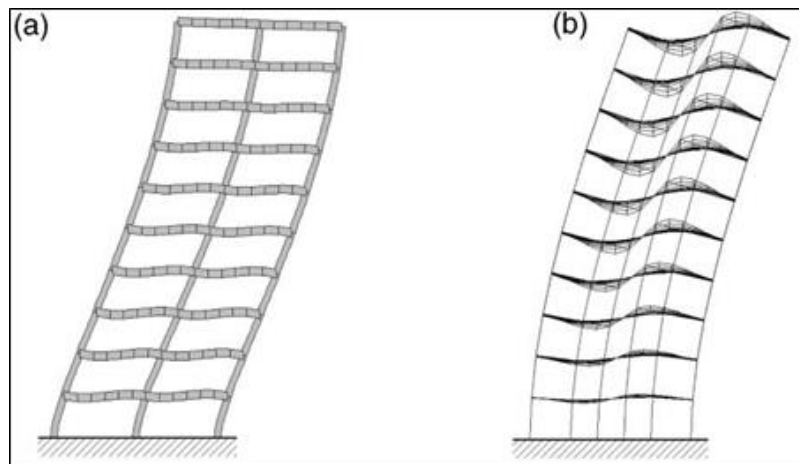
Deformación de la construcción de estructuras por las cargas laterales. (a) Tipo de plano A, (b) Tipo de plano B.
